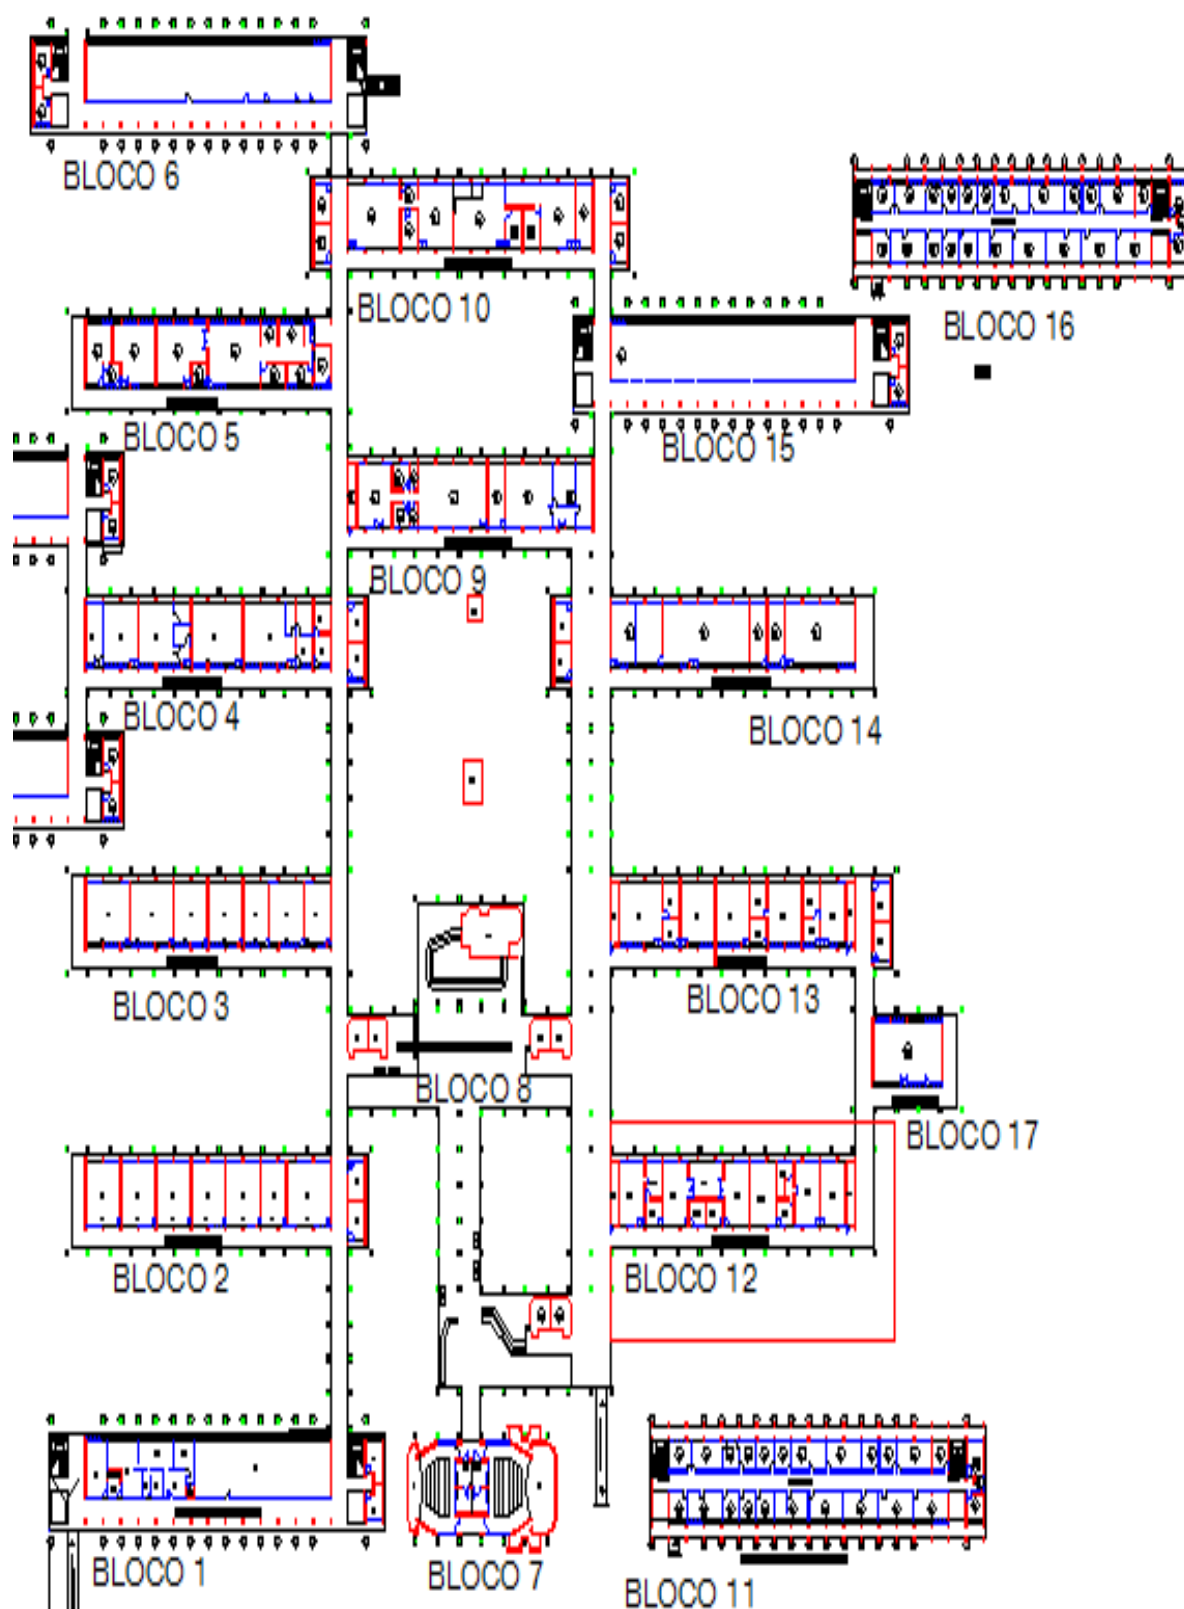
Planta Baixa da Faculdade de Tecnologia/UFAM
